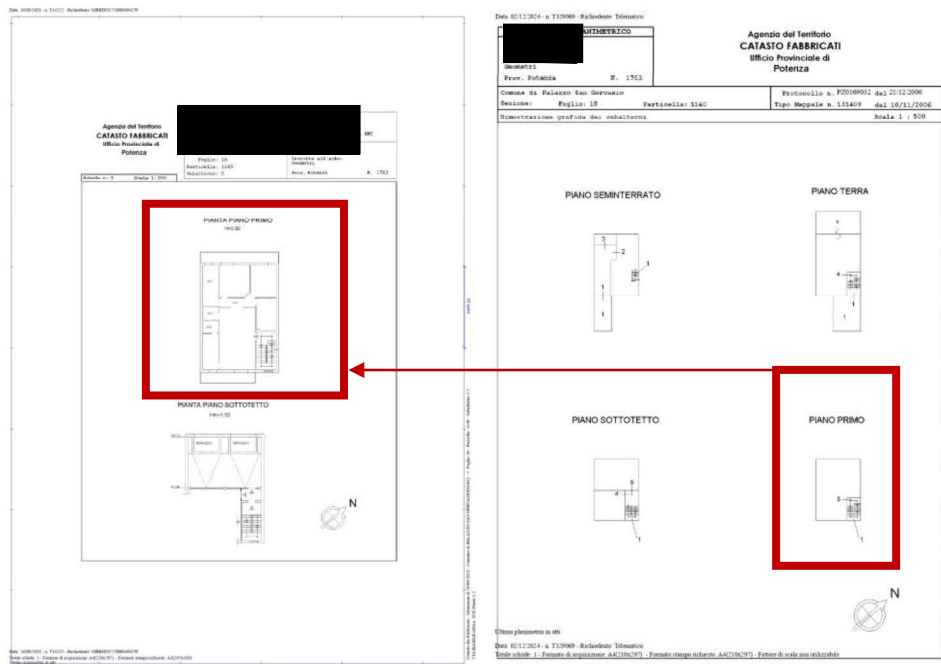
Planimetria Catastale ed Elaborato Planimetrico Lotto LU – Piano Primo (ALL. 06).
